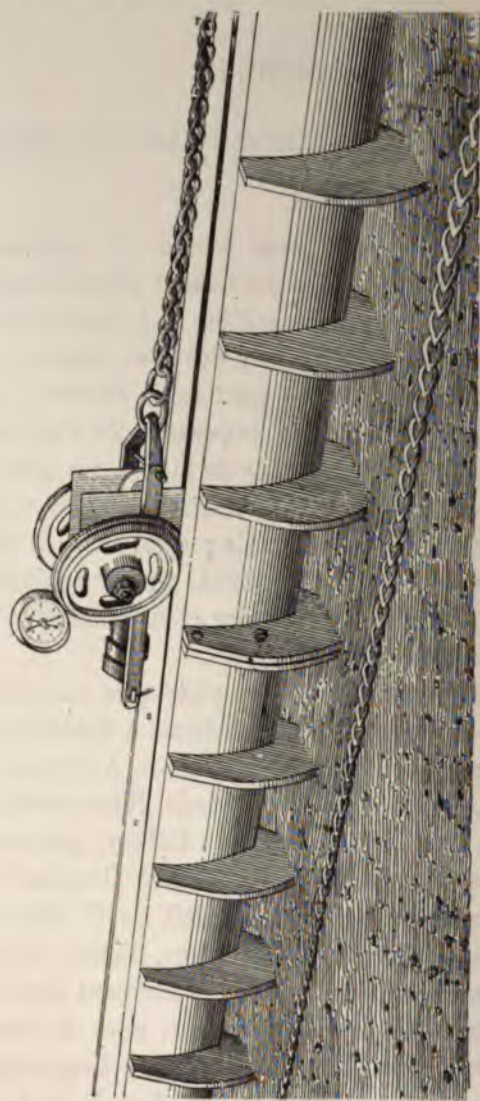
Vue extérieure du tube de l'ascenseur à air comprimé de Plainpalais.
